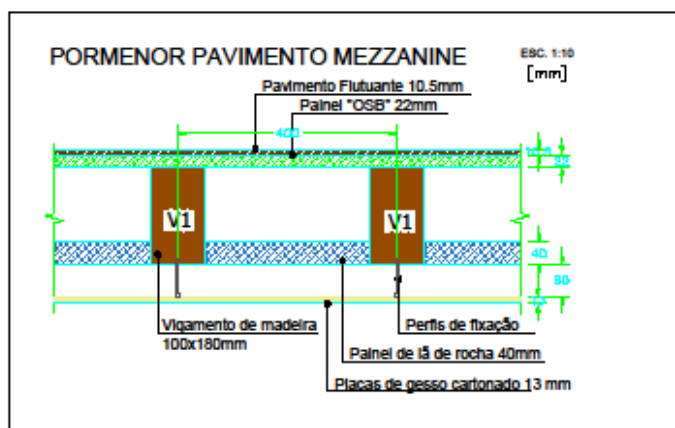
Pormenor do Pavimento da Mezzanine
